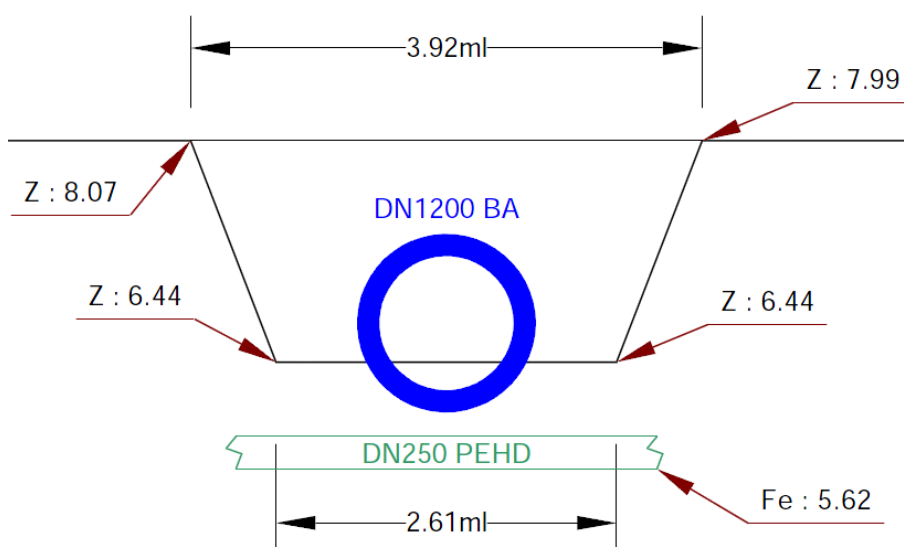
Profil en travers, après travaux, du ruisseau temporaire au droit de l'enfouissement de la canalisation de rejet et de la buse reprise (Source : INGEAU)
